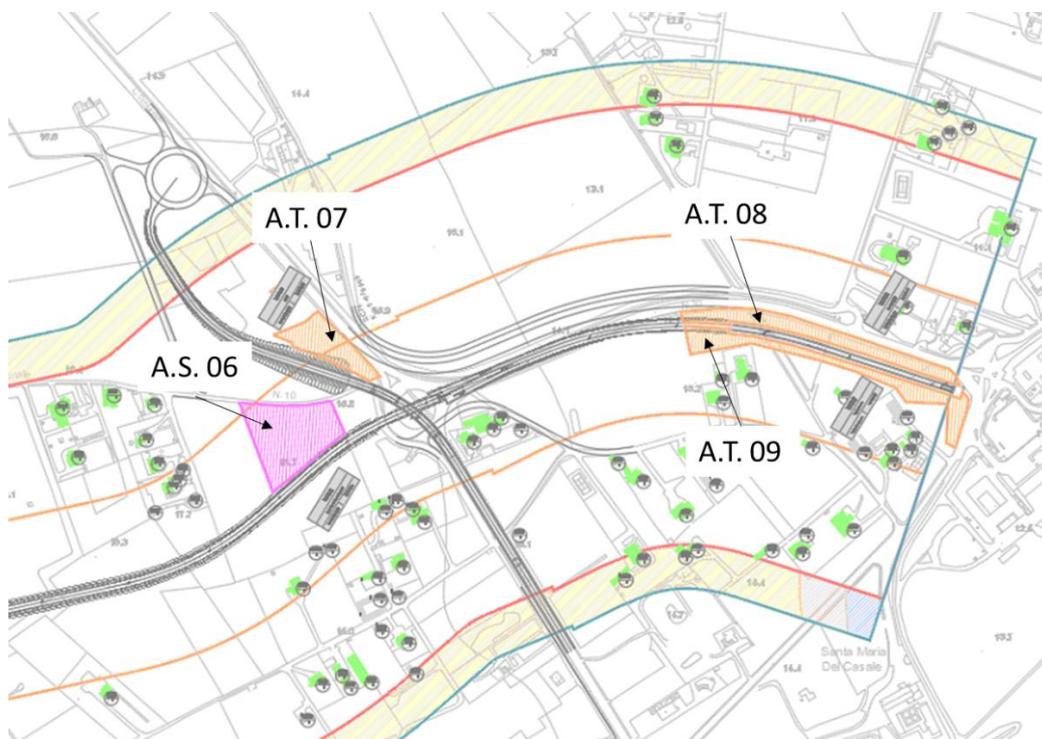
Localizzazione delle aree di cantiere e attività di lavorazione
